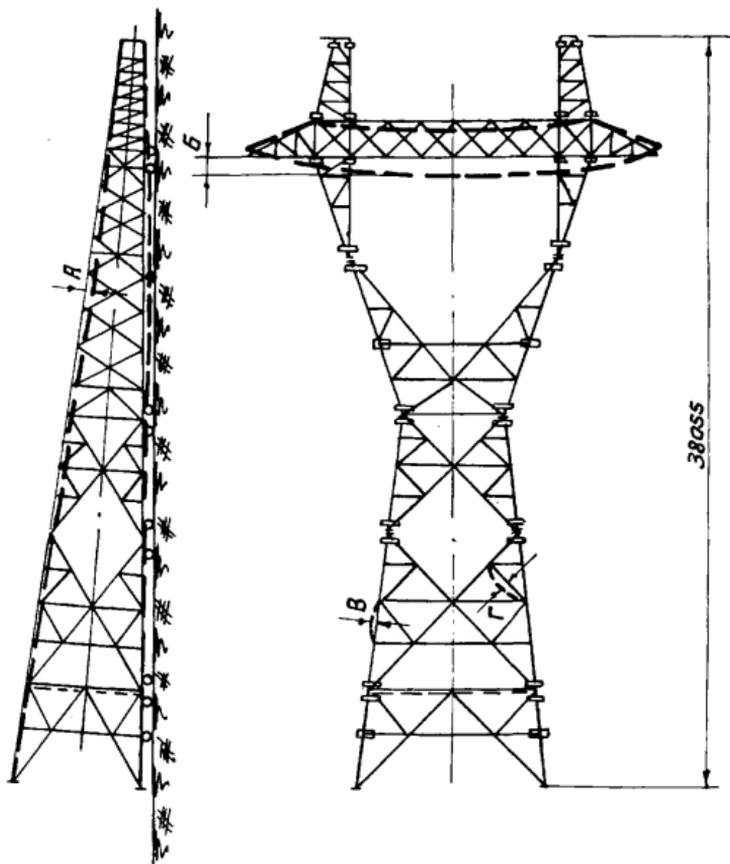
Допуски на сборку стальных опор ВЛ-500 №
